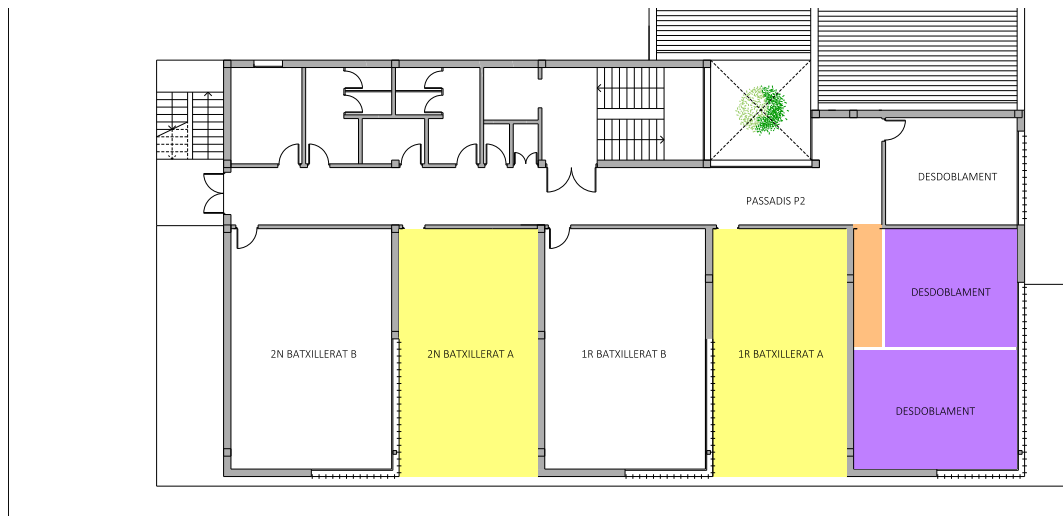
Proposta 1, Edifici D, Planta Segona. Font: Elaboració pròpia.
